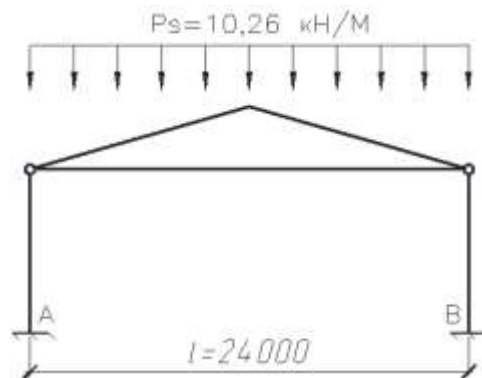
Розрахункова схема та зусилля на раму будівлі
